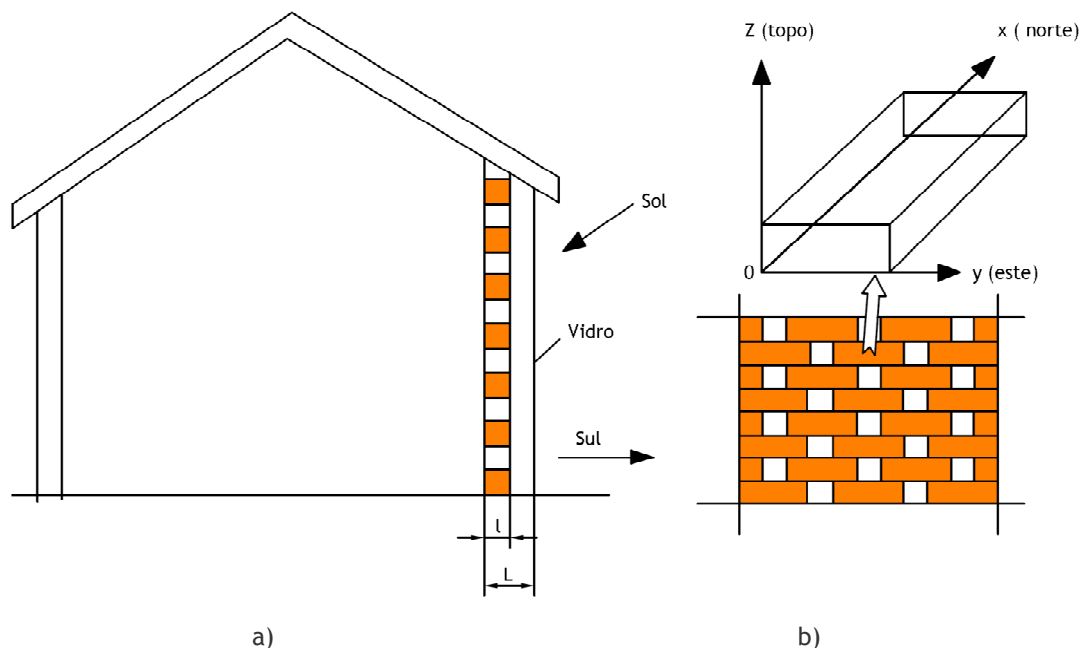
Desenho esquemático da “Lattice Wall” a) perfil transversal; b) vista frontal (adaptado de [128]).
